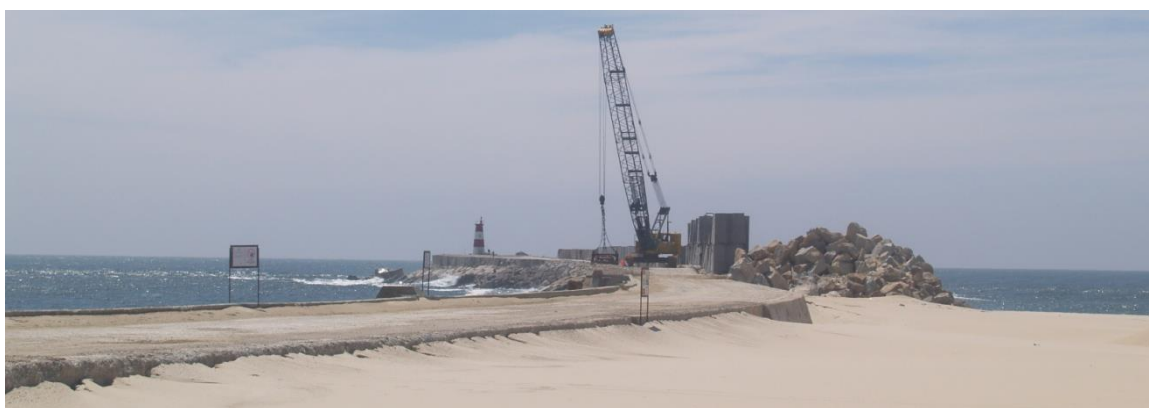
Aspeto inicial das obras de prolongamento do molhe norte do porto de Aveiro (Maio 2012, Paulo Correia Silva).
